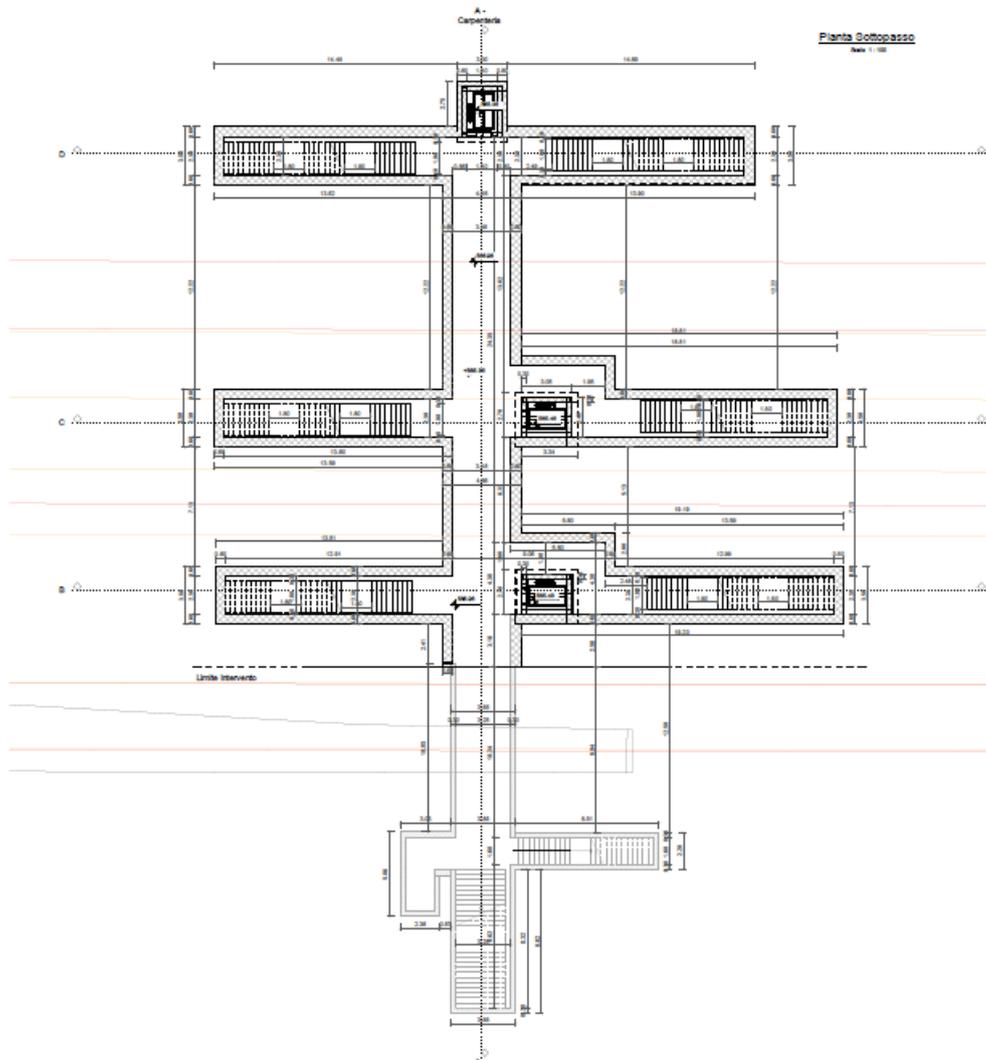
Prolungamento sottopasso di stazione SL01 – Pianta
